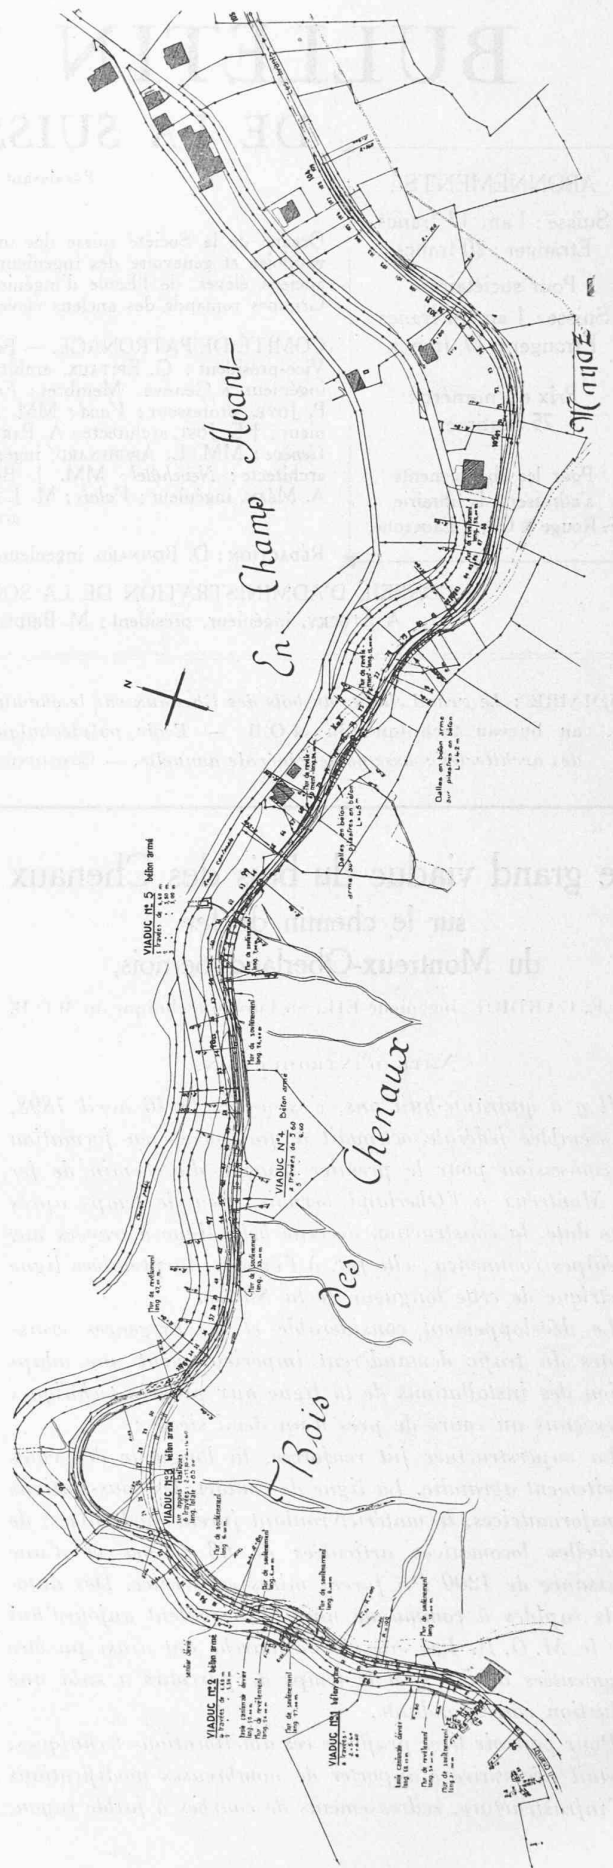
Plan de situation. — Echelle 1 : 4000.
